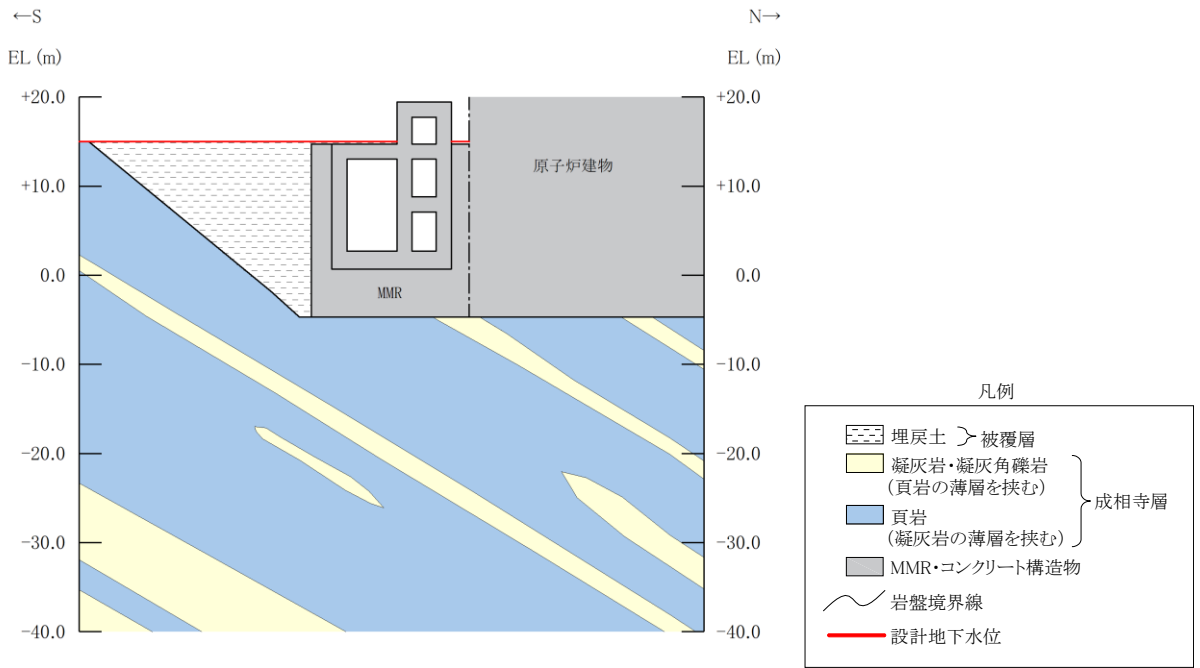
第 1 ベントフィルタ格納槽 評価対象断面図 (A-A 断面)
